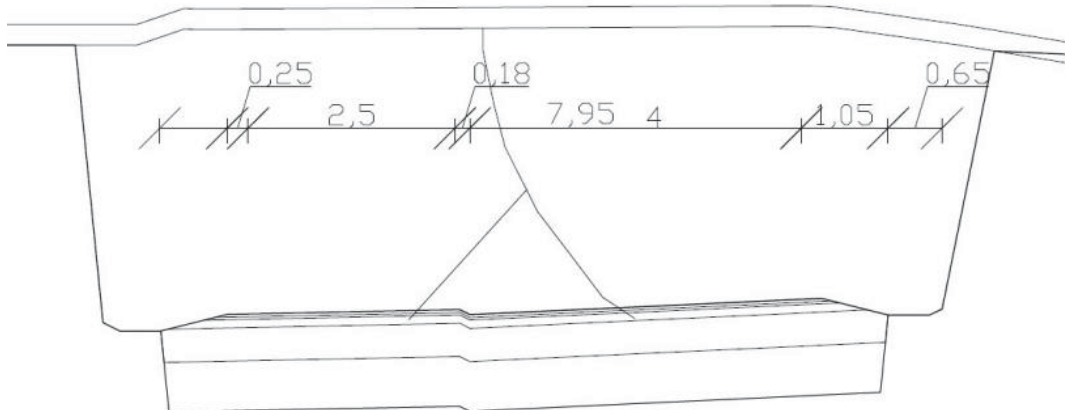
Horisontalkurvatur undergang profil nr 1530
